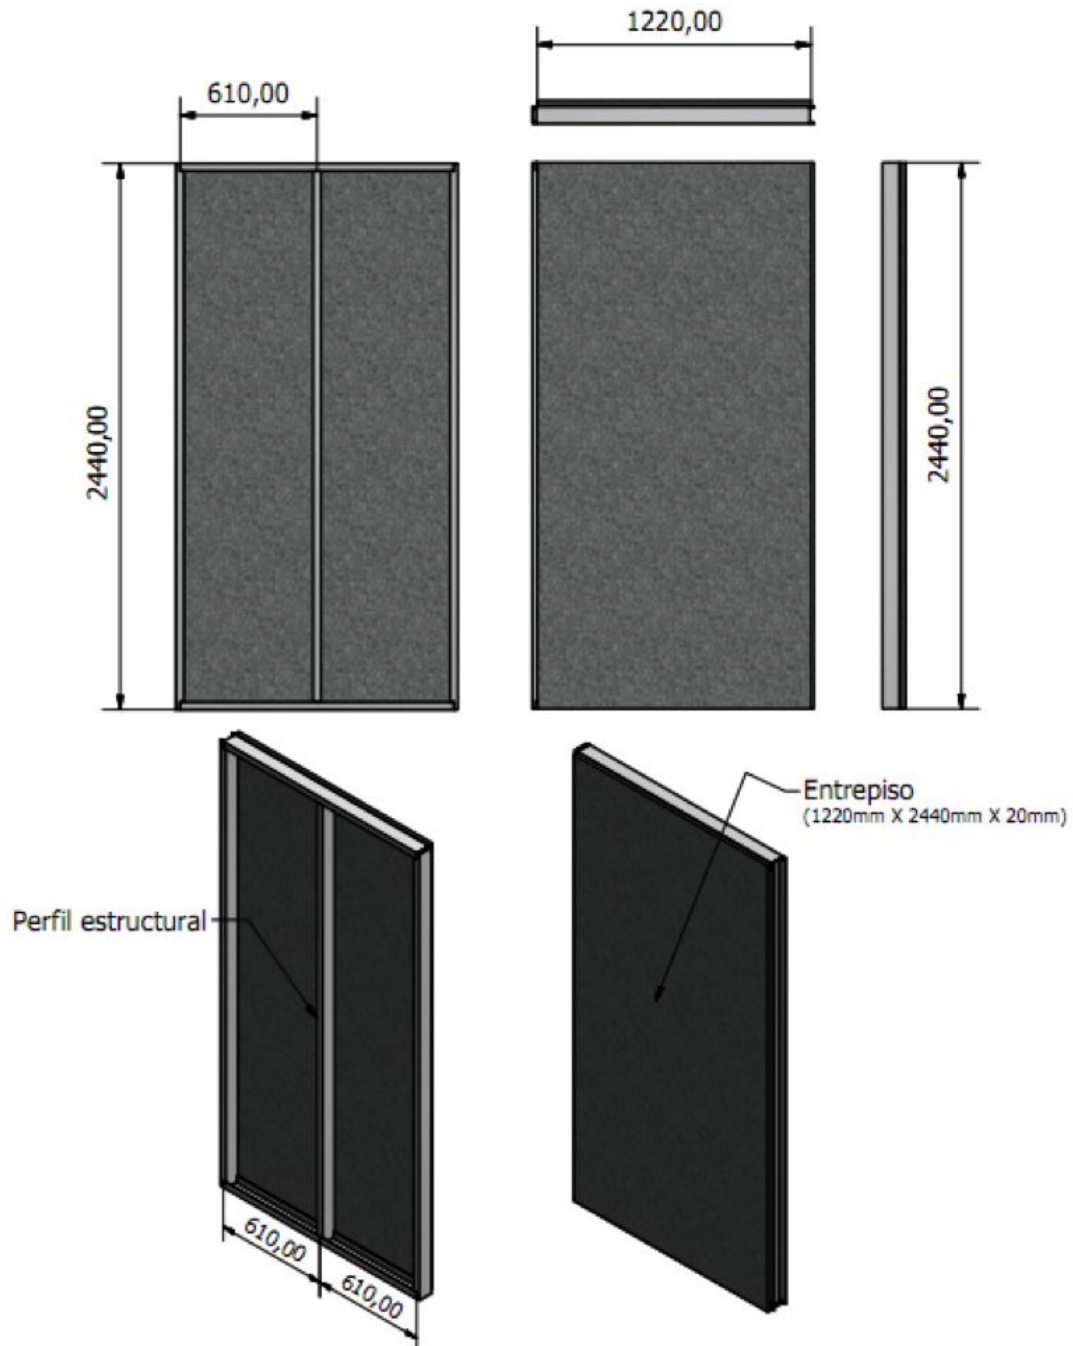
Sistema de instalación de lamina de 20 mm de espesor.
